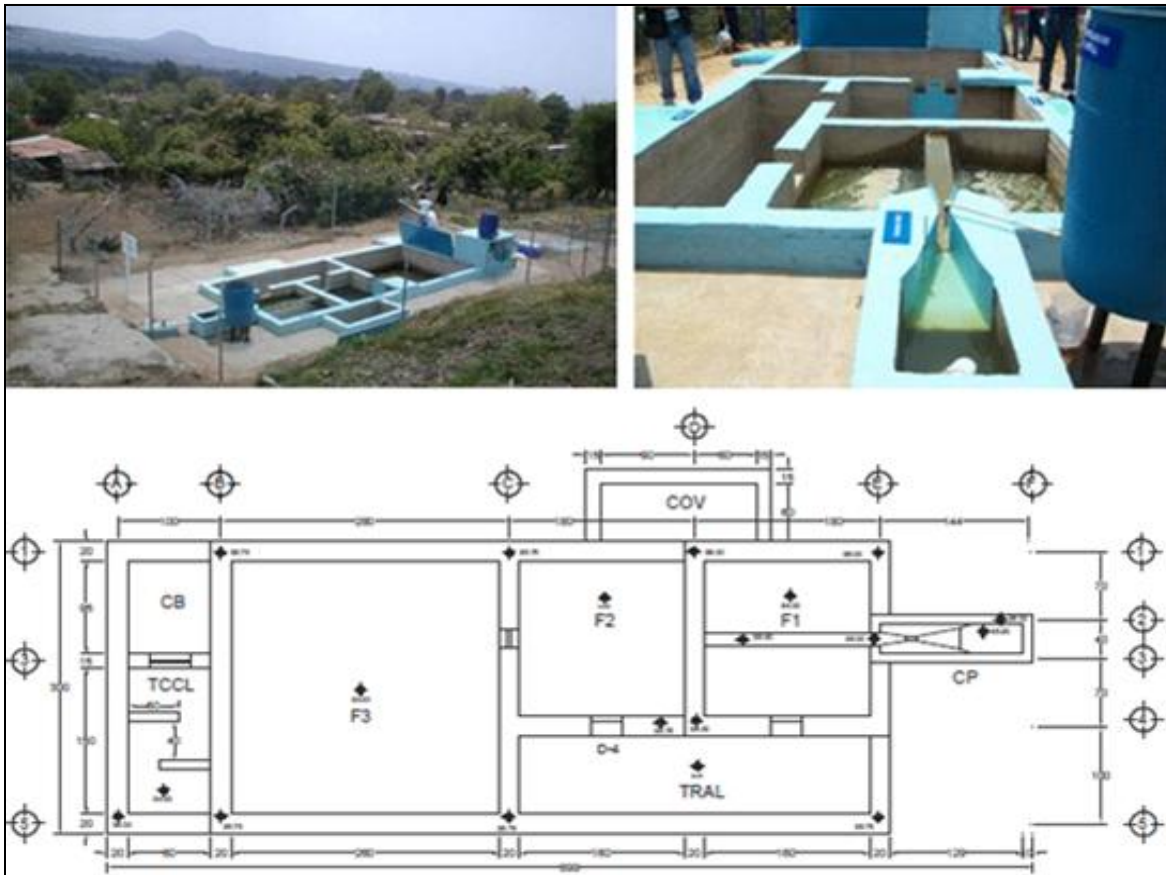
Sistema FIMEM, planta general y ejes de trazo.
